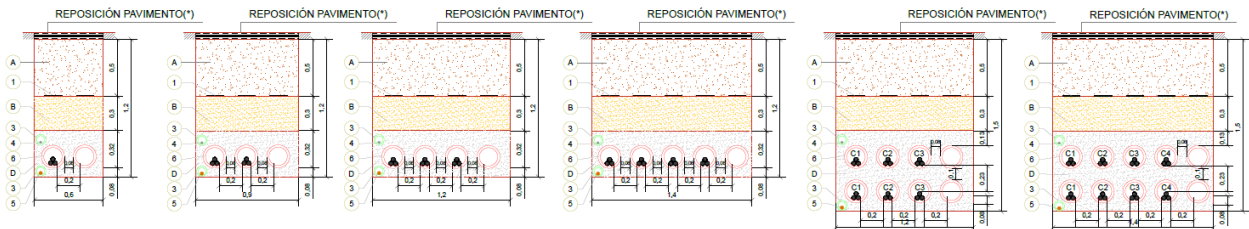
zanjas tipo conductor entubado bajo viales/caminos o drenajes.
